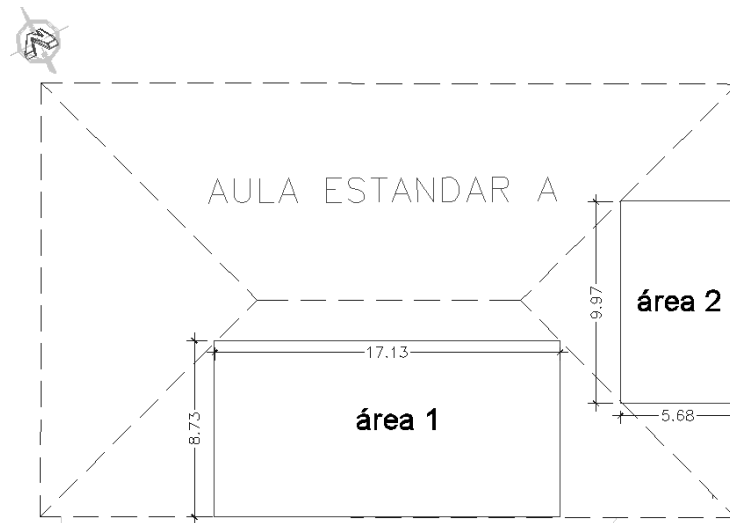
Vista en planta del edificio de aulas A y área a considerar.
